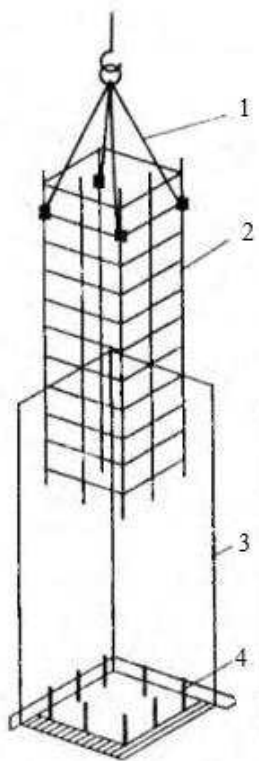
Схема монтажа арматурного каркаса колонны:
